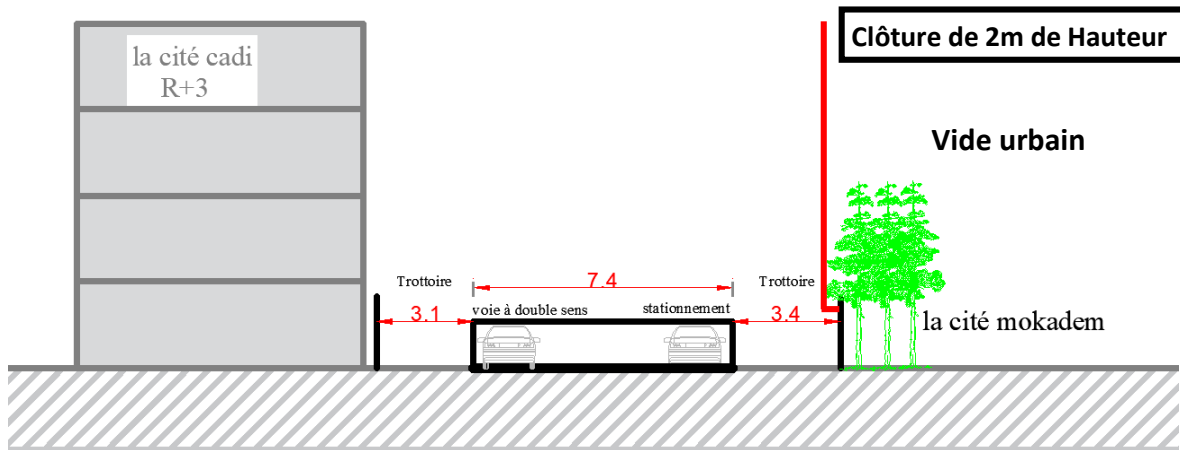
Coupe schématique transversale sur la rue KESRI.
